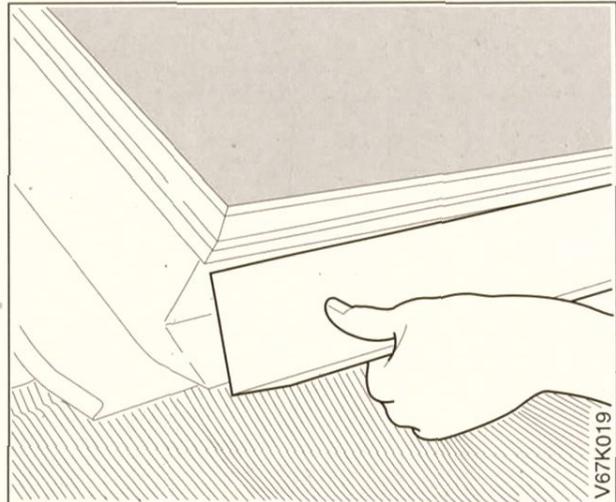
Abschlussbleche unten - am linken Kollektorrand beginnend - in Kollektornut einstecken.
